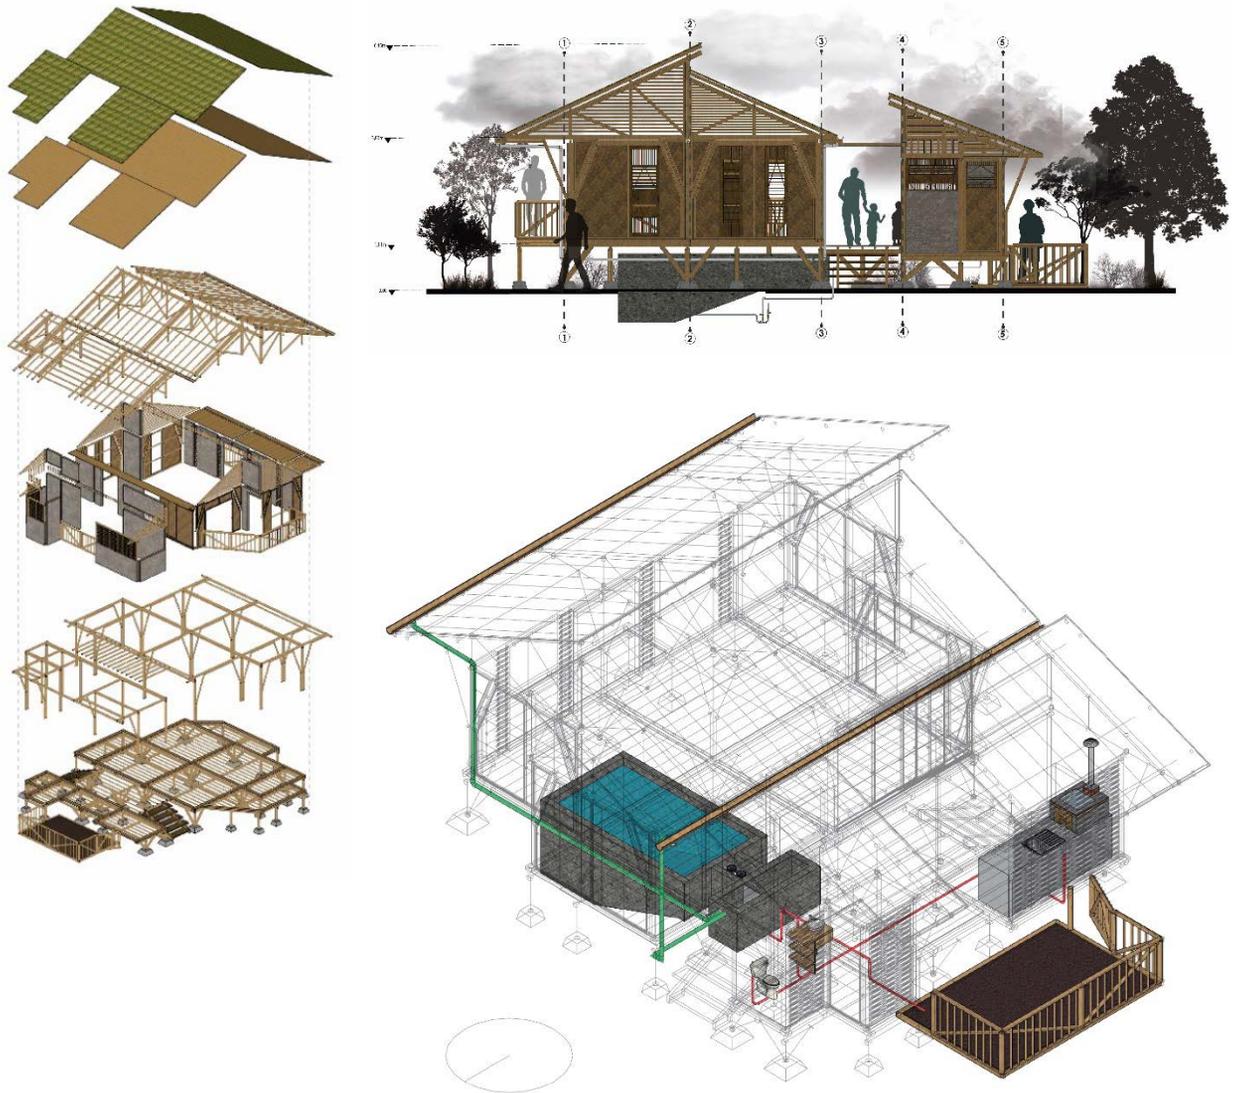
Proceso de diseño / Despiece constructivo / Planta y alzado vivienda / Recolección de aguas
